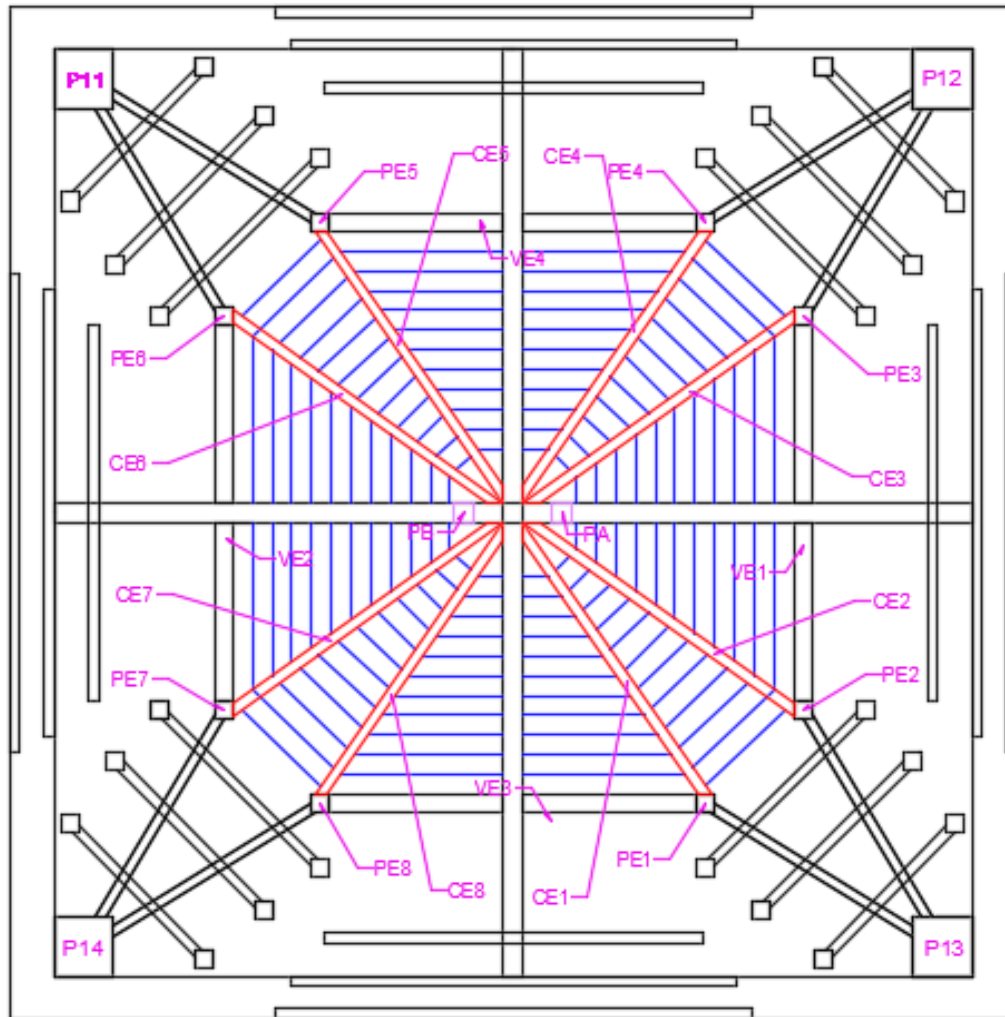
11 Planta estructura nivel entresuelo Torre del Reloj de Iquique
